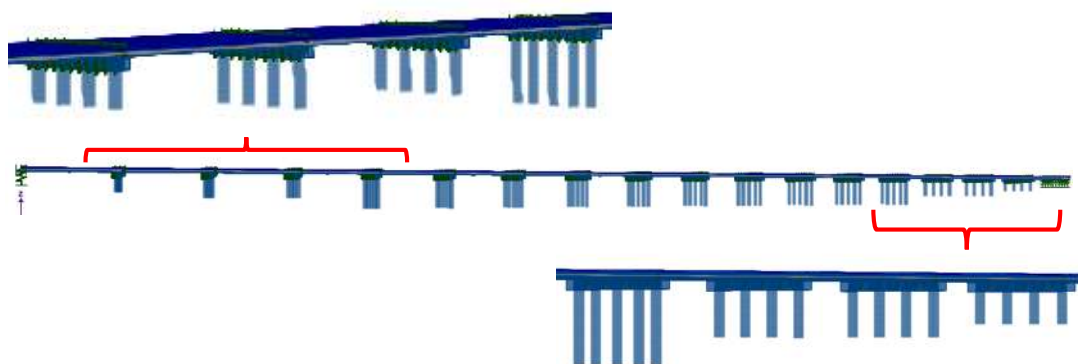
Disposición del número de columnas en las pilas del puente Miguel Alemán.
